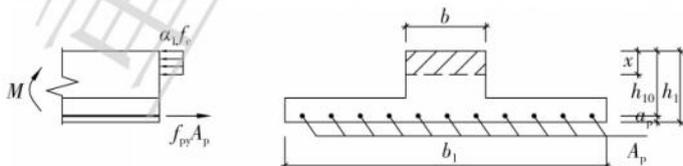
预应力混凝土带肋底板正截面受弯承载力计算
